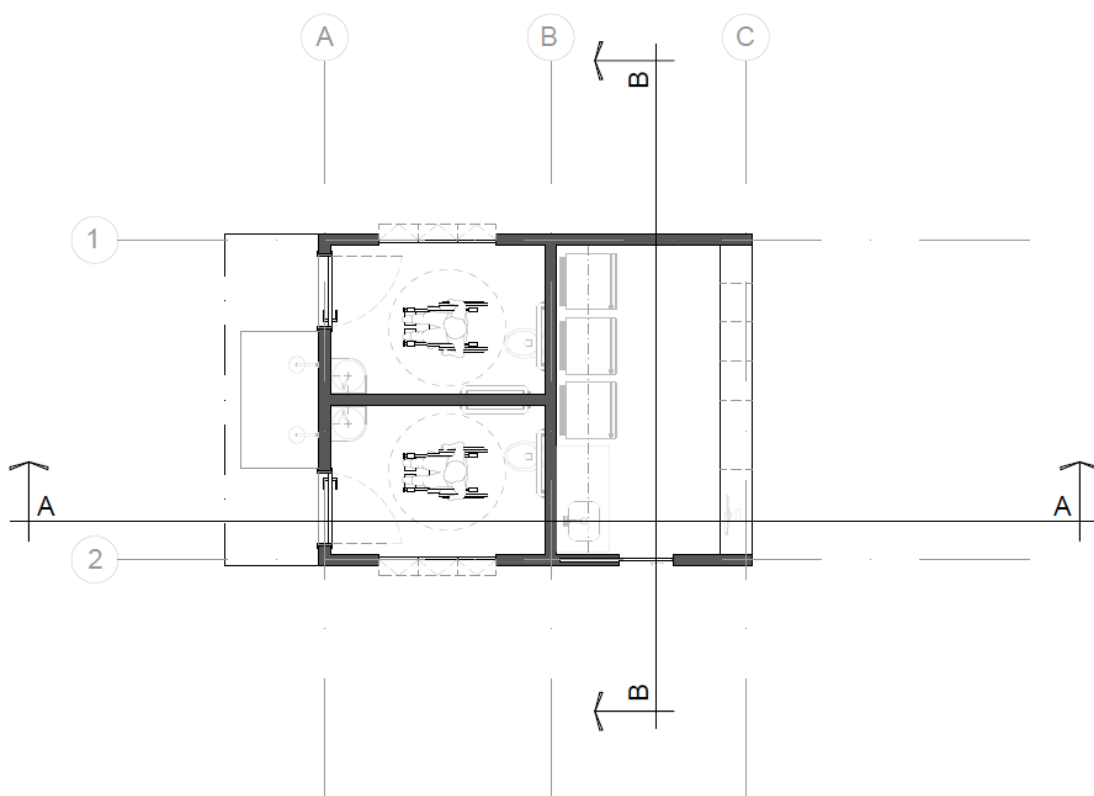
Planta baixa do equipamento 12 (Bar próximo ao Rio Betione)
